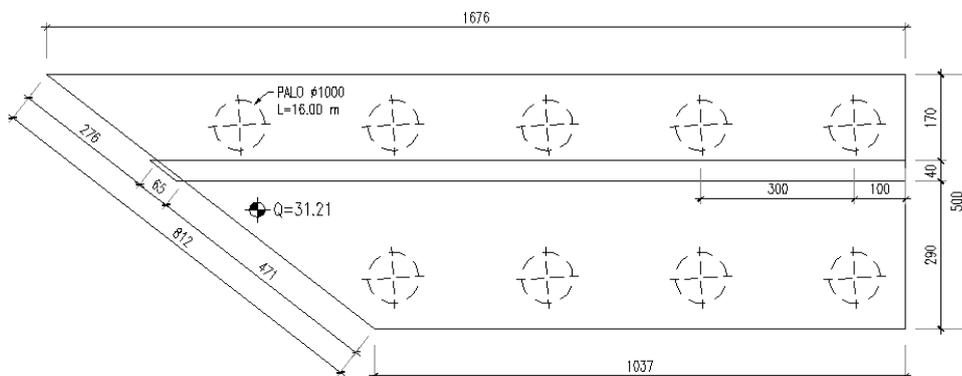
Planimetria fondazioni e prospetto muro contenimento lato Spalla 1 sx
